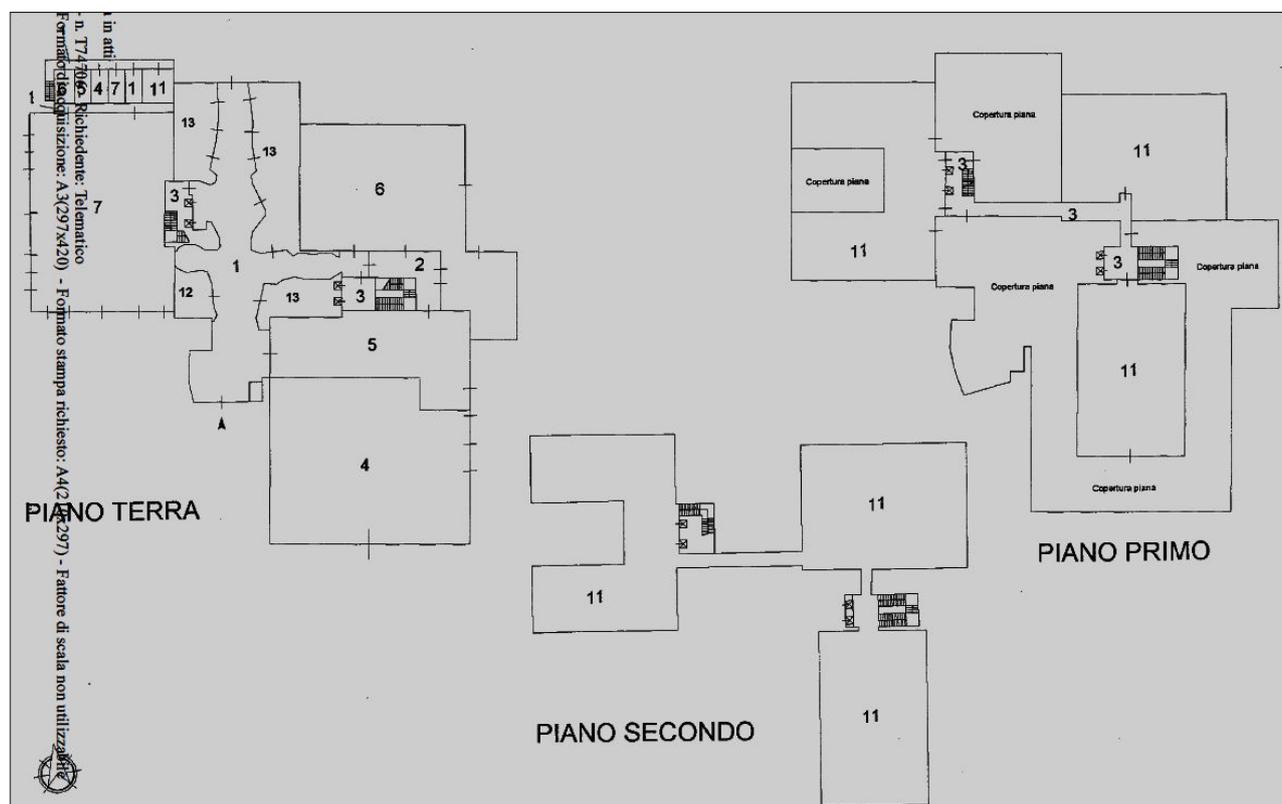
Elaborato planimetrico con indicazione dei subalterni
